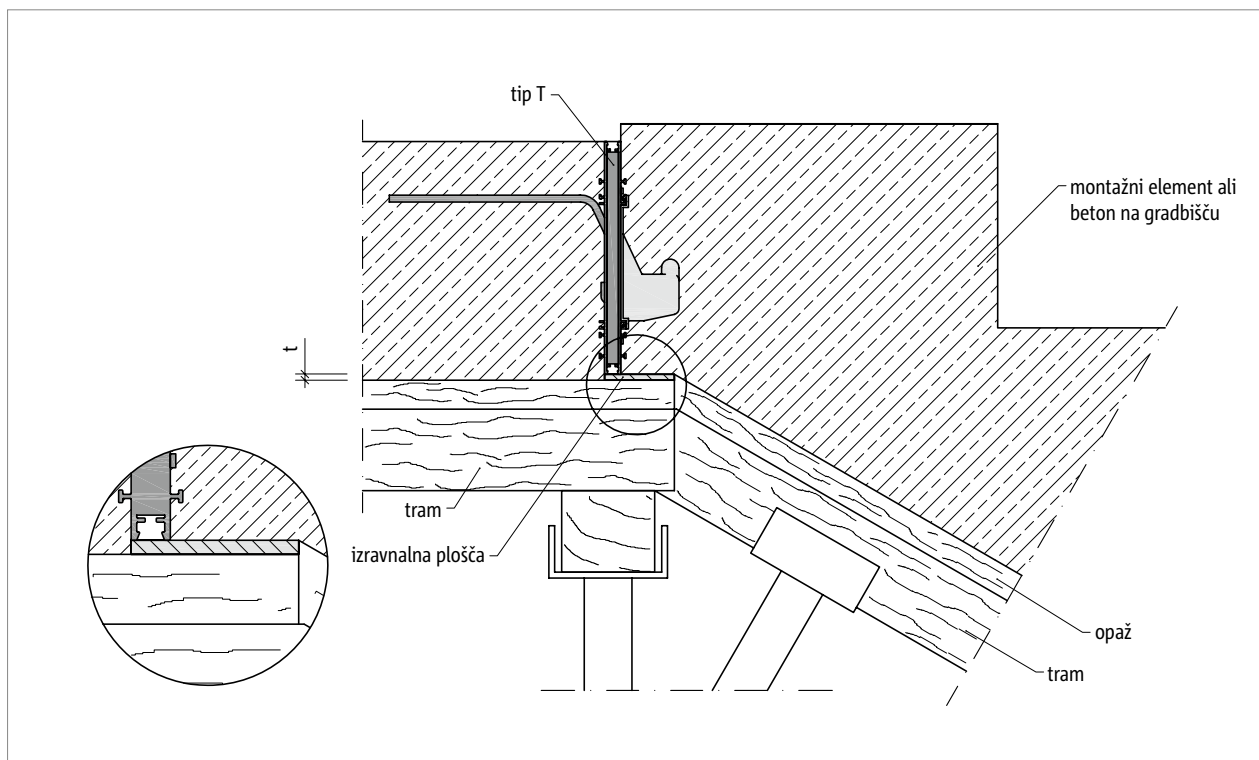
Schöck Tronsole® tip T: deformiranje elastomernega ležaja Elodur®
